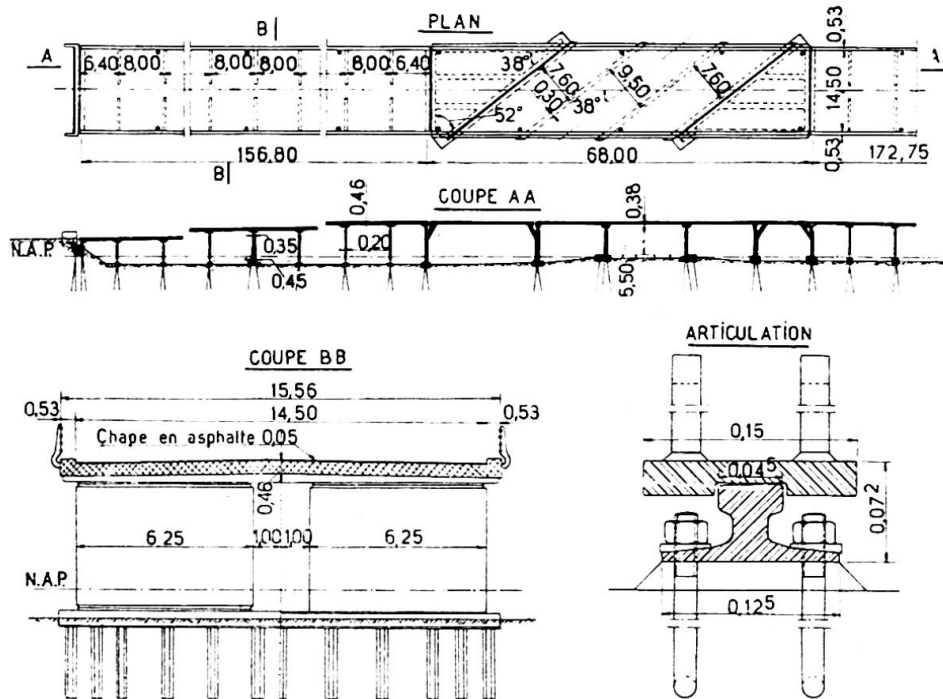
Plan et élévation du passage supérieur avec ses rampes d'accès.
